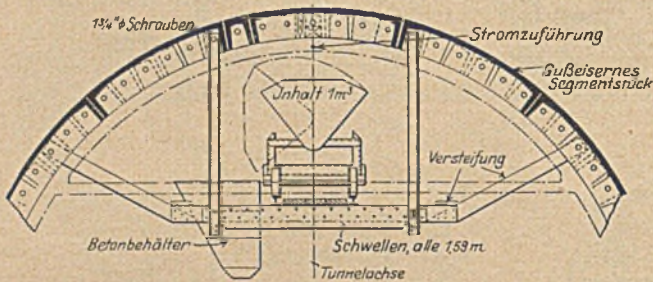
Fördergleisauflängung im Tunnelrohr.
